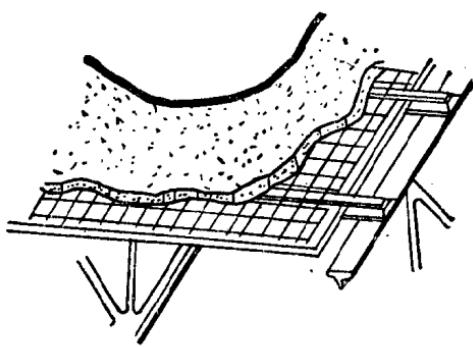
在木模板上铺膨胀蛭石钢筋混凝土
